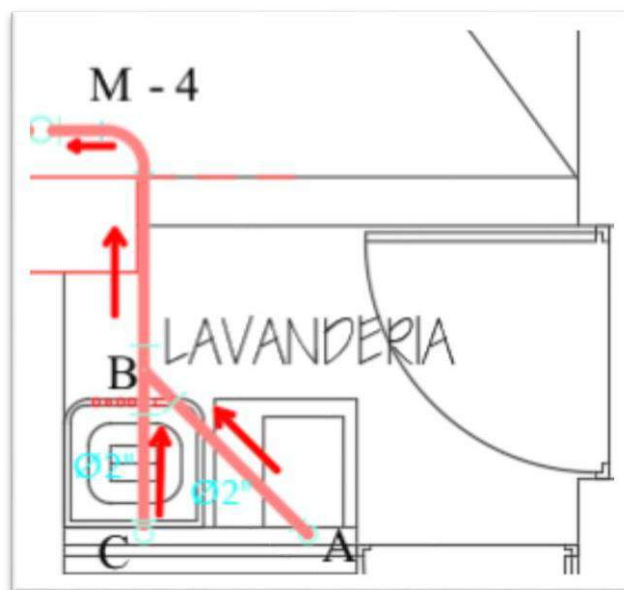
Distribución de descargas en lavandería – Dpto 102, Primer nivel
